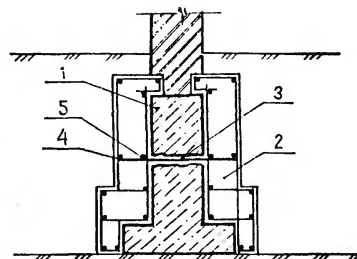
Увеличение ширины подошвы ленточного фундамента устройством приливов из бетона
